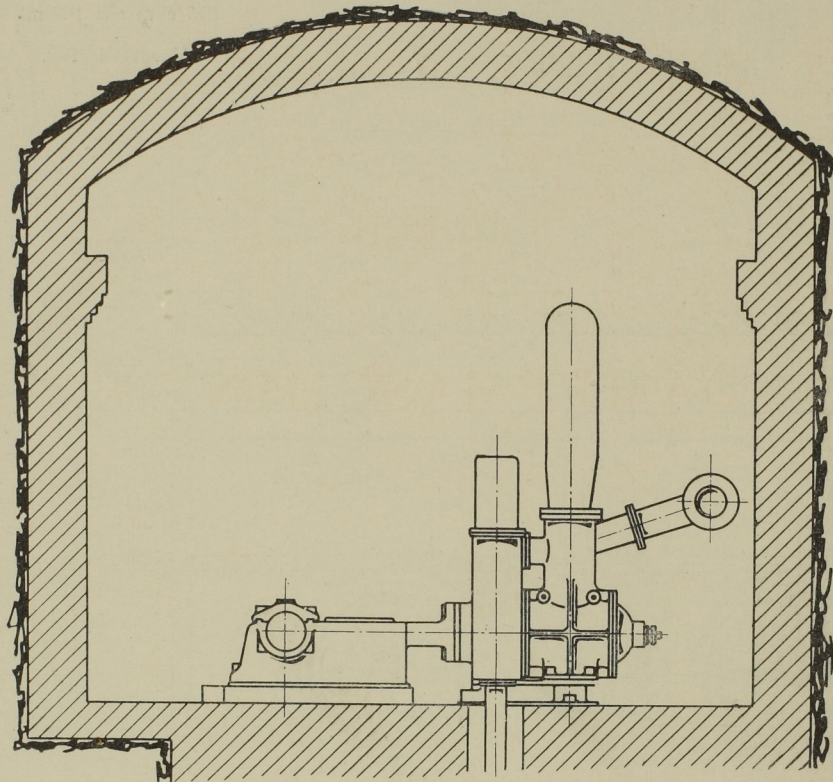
Seitenansicht der Pumpe und Querschnitt des Maschinenraumes.
